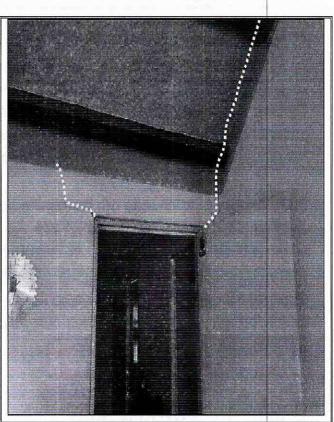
Fisuras y grietas en muros de cerramiento y divisorios identificadas en la vivienda del predio de la Calle 174 No. 57 - 40, en el Sector catastral Villa del Prado de la Localidad
